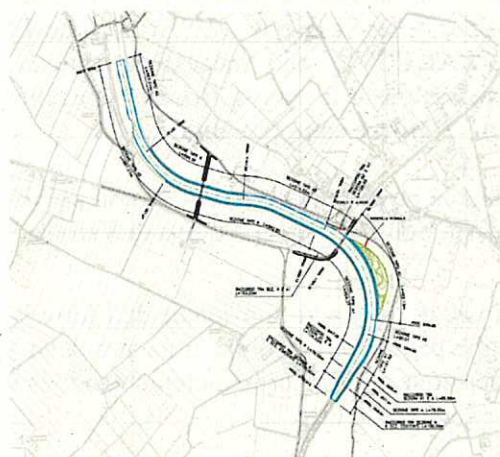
Planimetria generale degli interventi (appalto - anno 2011)
